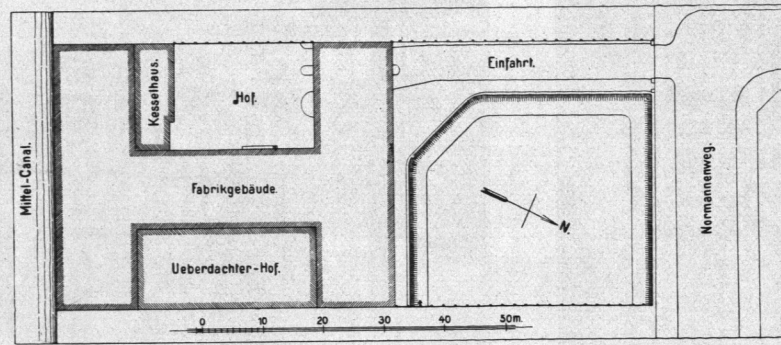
Nähmaschinenfabrik Guhl & Harbeck, Lageplan.
